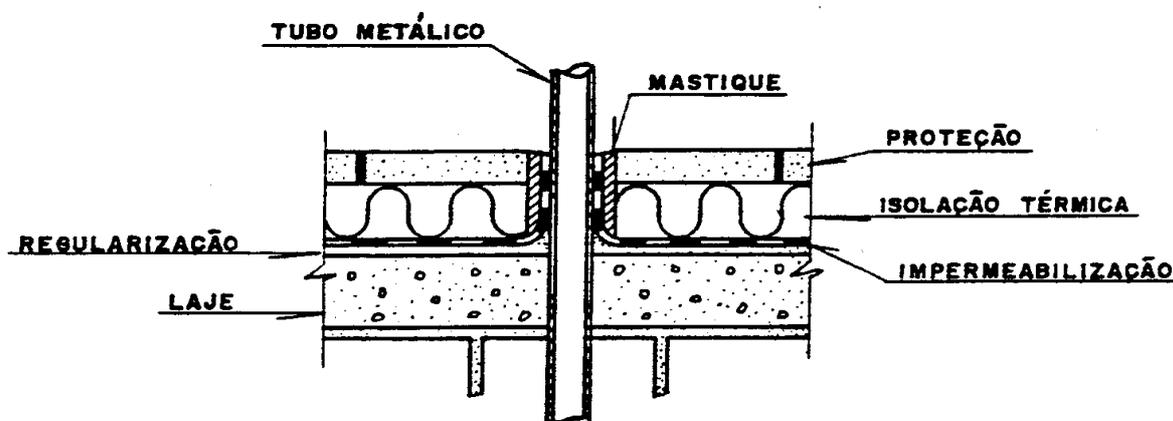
Peças que atravessam a impermeabilização – tubo metálico
